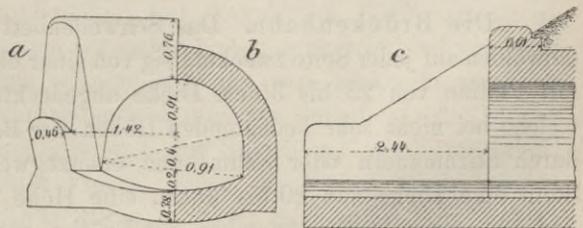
Durchlaß der Altenbecken-Holzmindener Bahn.
